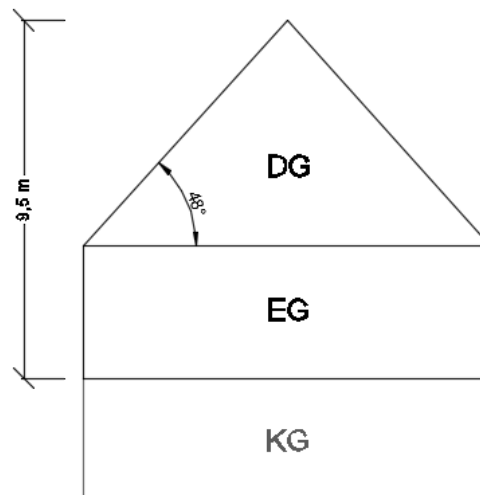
Beispiel für Geschosse, und Dachneigung
